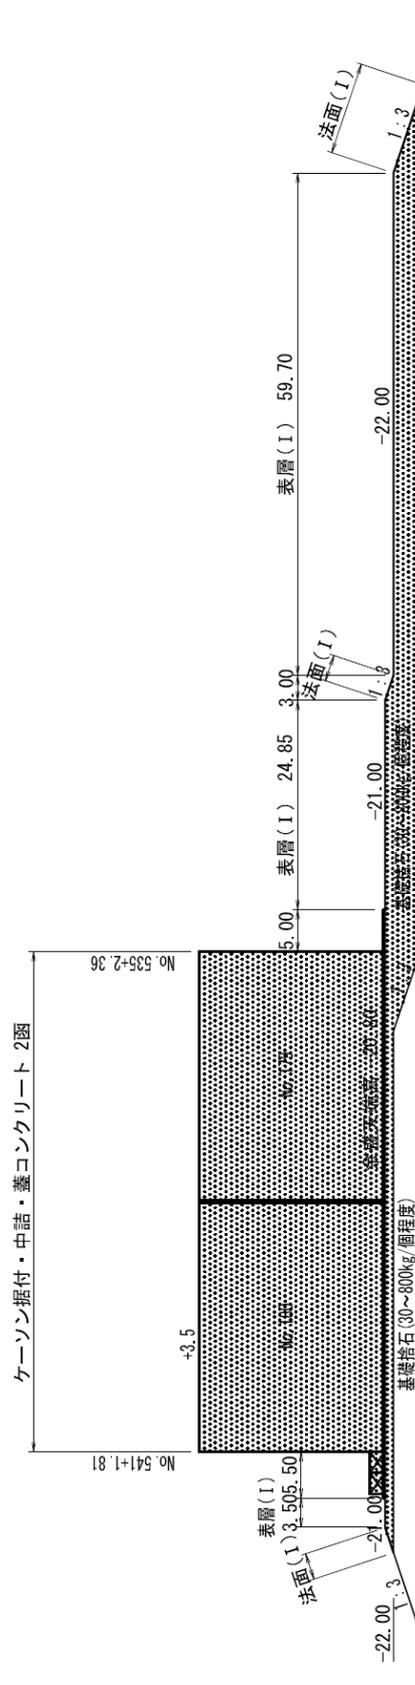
No.2 常陸那珂港区_東防波堤断面図 A-A' (被災前)
